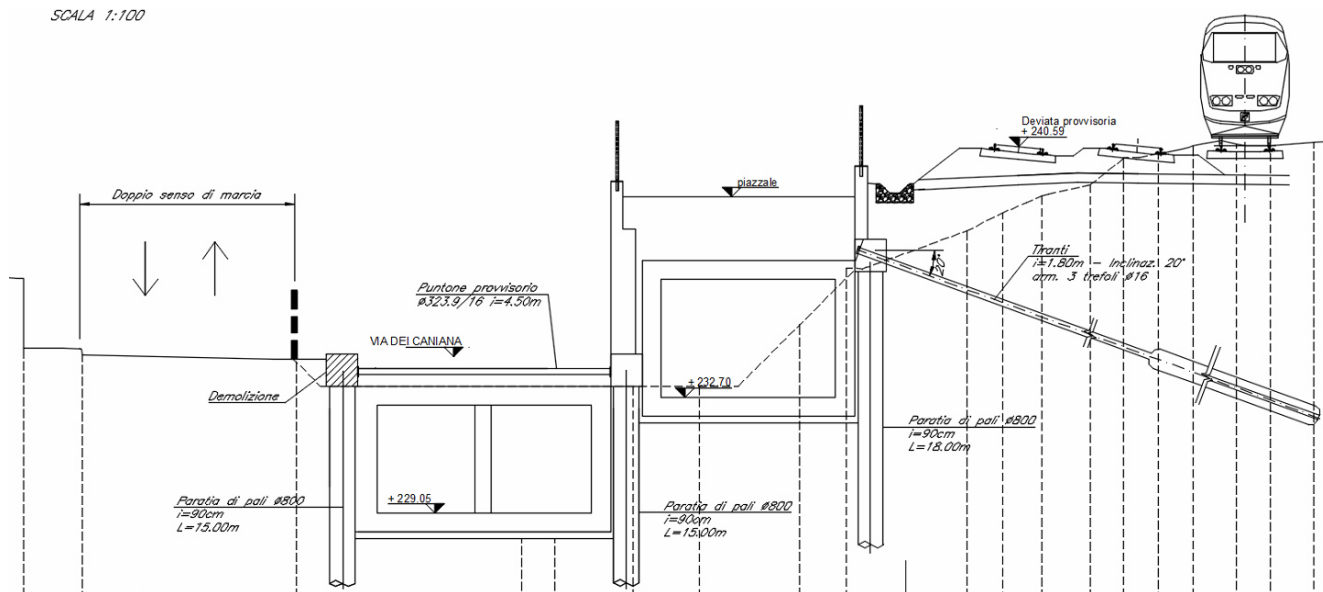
sezione trasversale con indicazione delle opere di sostegno
